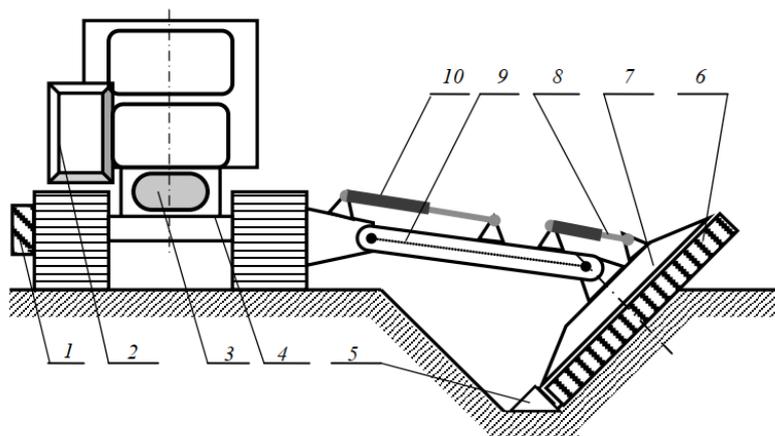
Каналоочиститель с фрезой, имеющей ось вращения, перпендикулярную откосу: 1 — боковой противовес; 2 — бак гидросистемы; 3 — насосная установка; 4 — трактор; 5 — зачистное пассивное устройство; 6 — фреза; 7 — кожух; 8 — гидроцилиндр; 9 — рама; 10 — гидроцилиндр
